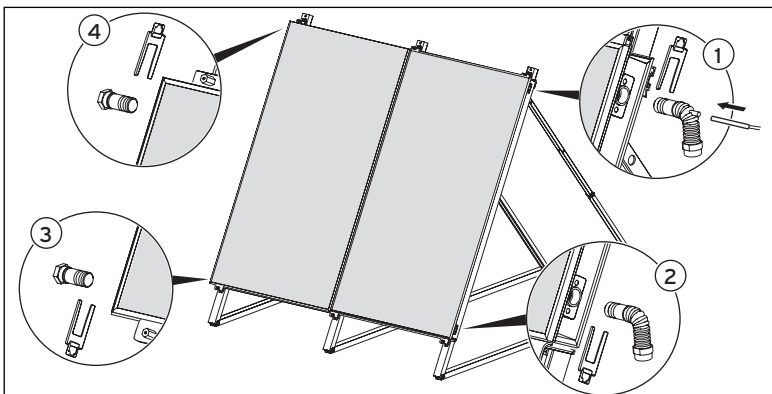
Hydraulische Anschlüsse montieren (1 - 5 Kollektoren)
